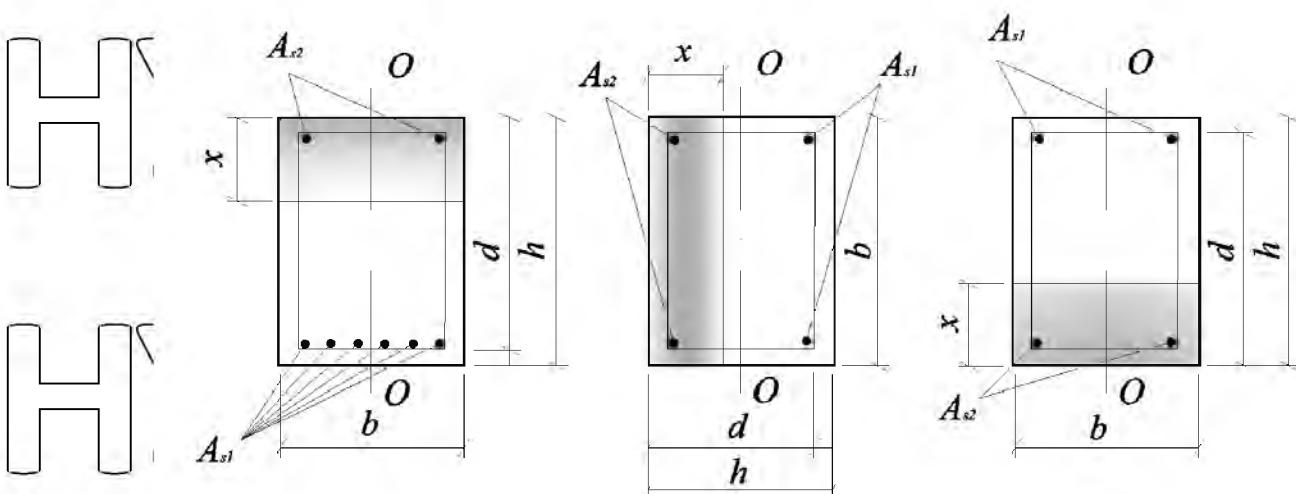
Схема зусиль у просторовому перерізі залізобетонного елемента
